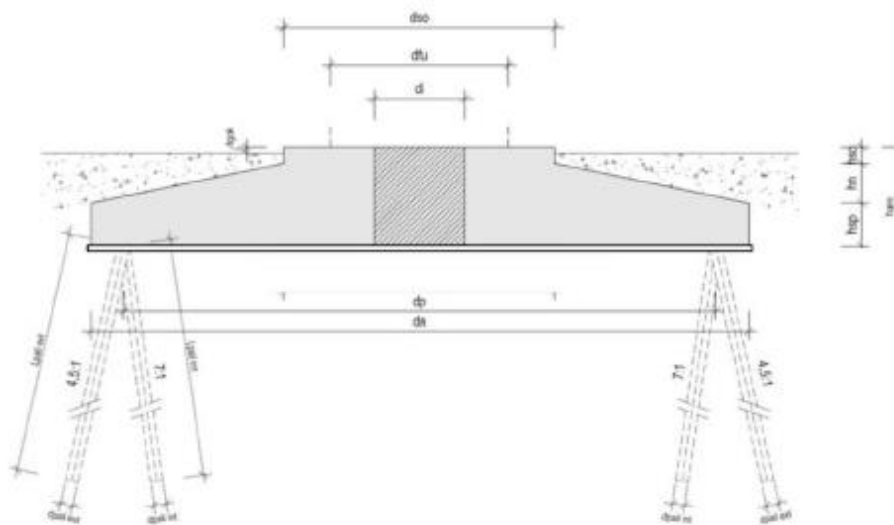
Andamento geometrico della fondazione (sezione – non in scala).
